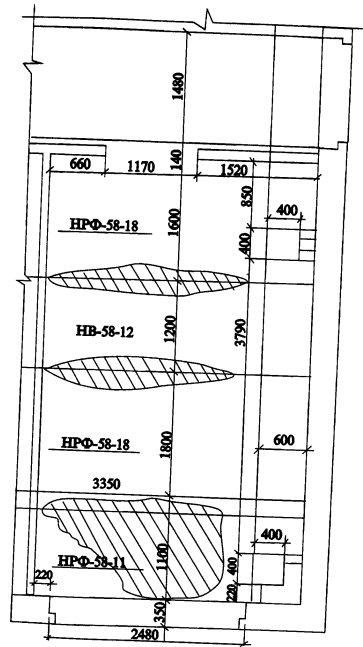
План помещения, пострадавшего от пожара. Штриховкой обозначены места с разрушенным или отставшим защитным слоем бетона плит перекрытия
